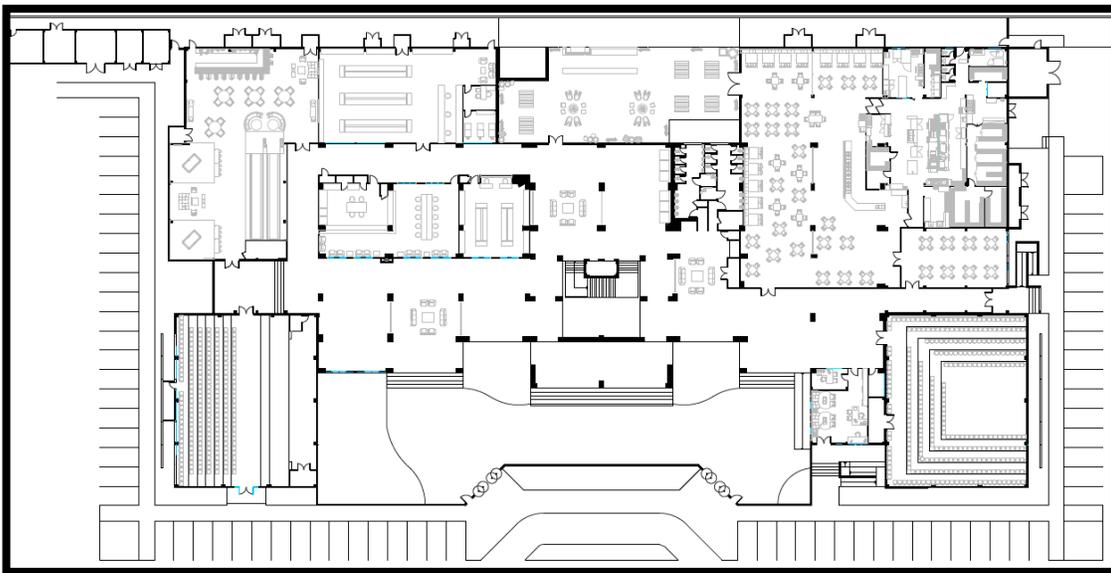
Plano de la Planta Baja, Rediseñado por: Srta. Danica Kusijanovic.
